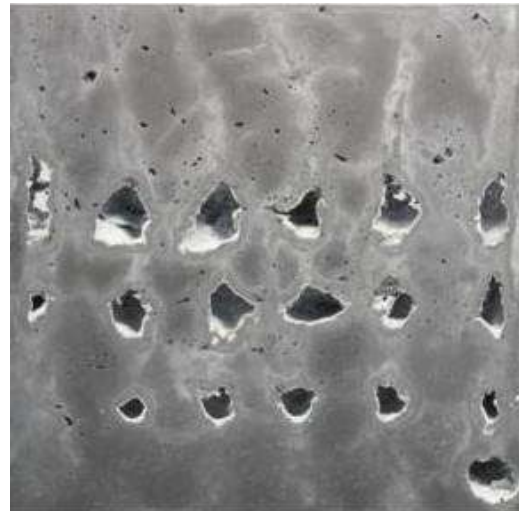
Stvarni prikaz postupka injektiranja betona u suspenziju
